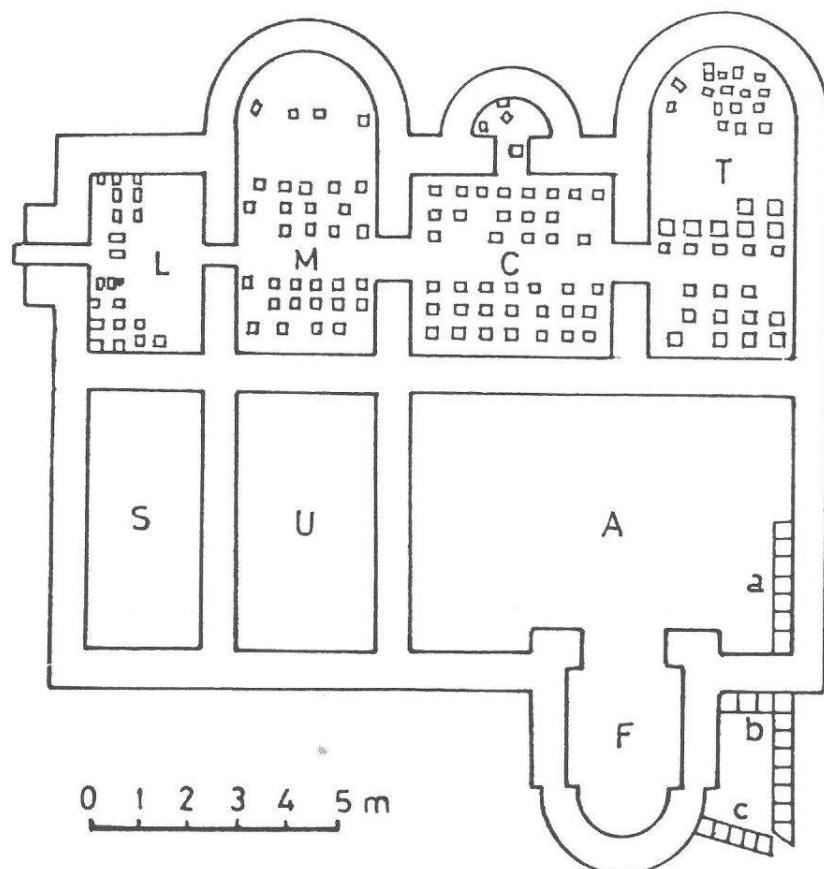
Slăveni, Plan des Bades (nach D. Tudor).
